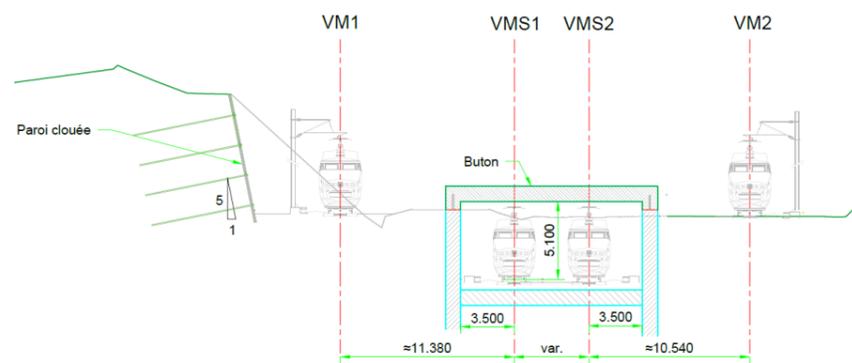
Profil en travers – tranchée ouverte, zone butonnée (Source : EGIS, 2021)
